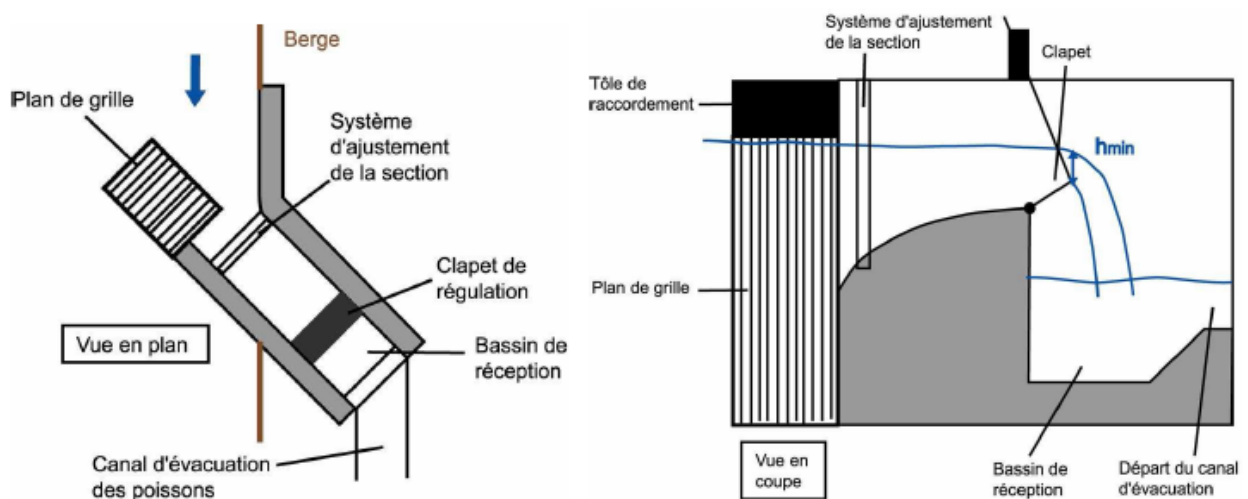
Vue en plan (à gauche) et en coupe (à droite) d'un exutoire de surface terminal au niveau d'un plan de grille orienté (d'après [Réf.A])
